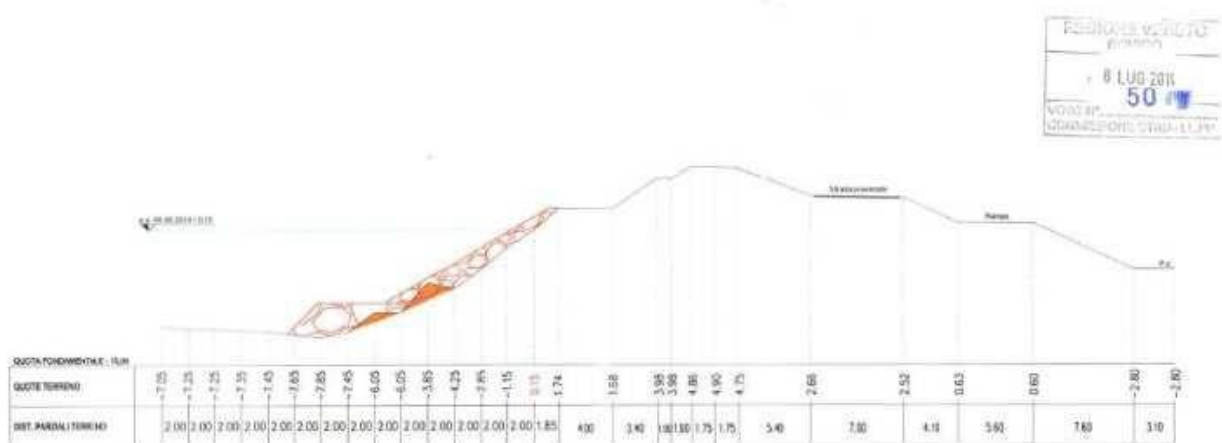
Esempio 4: sezione tipo difesa spondale Po.
